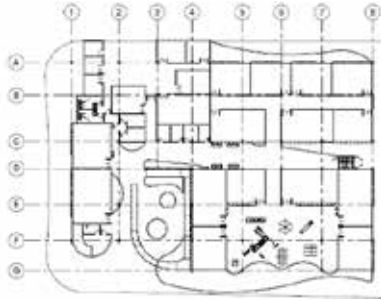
Imagen de Planta baja de Centro Educativo de Inicial y Básico.
